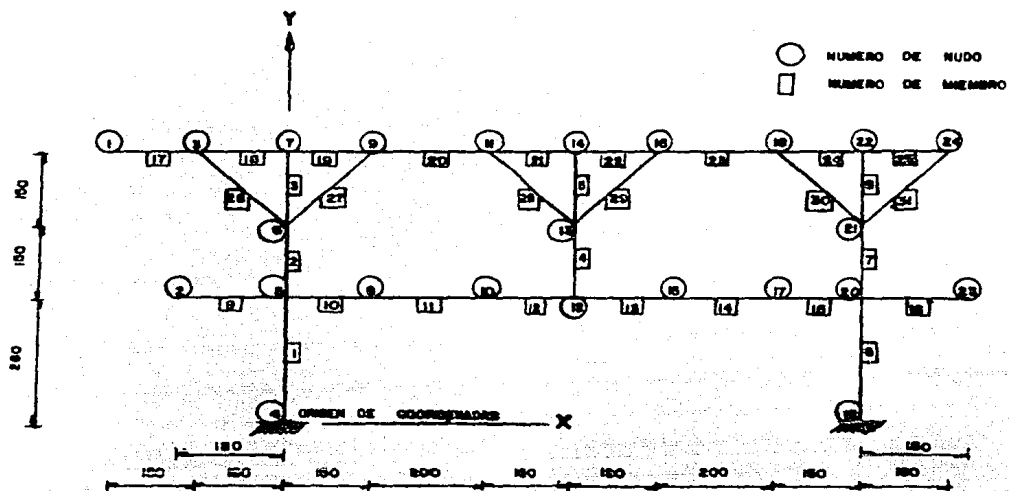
ESTRUCTURACION PLANTA EN ELEV. 110.600
